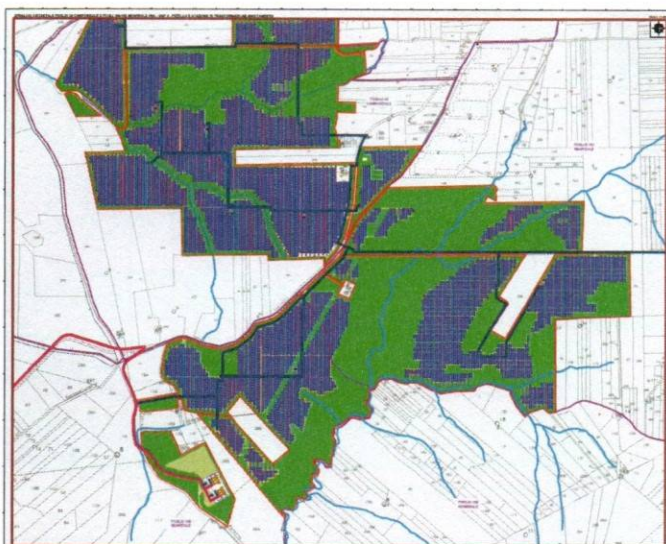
Elaborato di progetto "Carta di layout Pizzillo"
